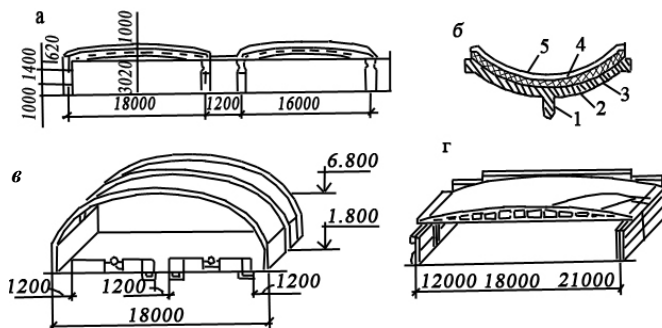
Покриття із залізобетонних панелей оболонки:
